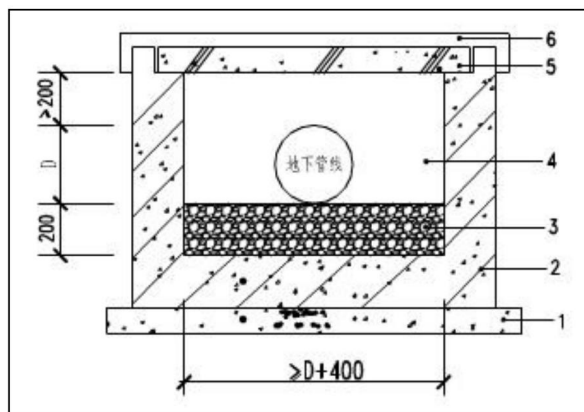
抗渗钢筋混凝土管沟防渗层示意图
